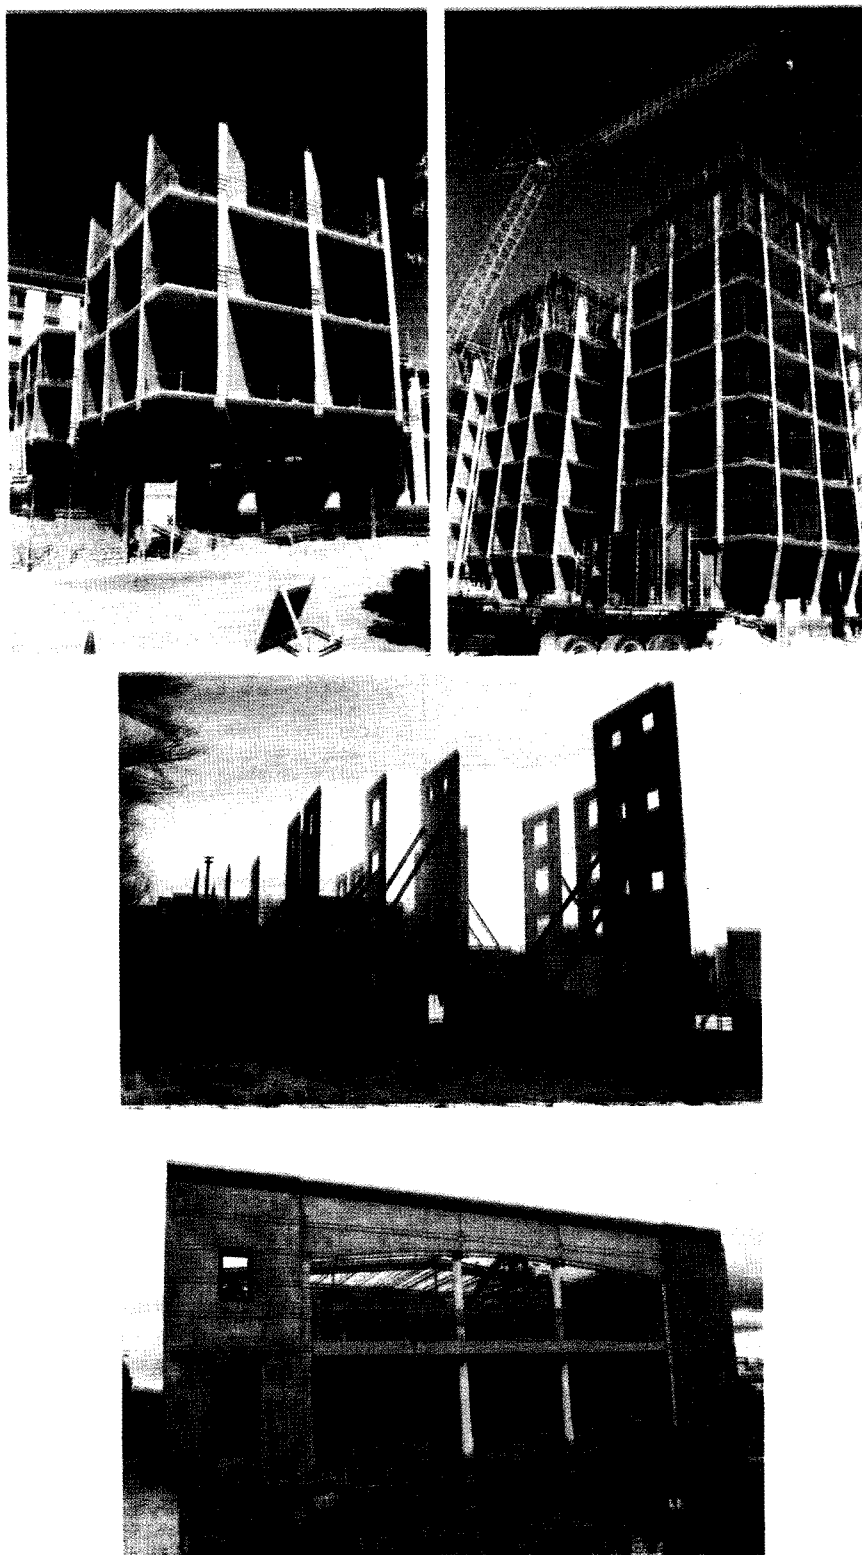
Ejemplos típicos de estructuras con paneles prefabricados de hormigón armado
